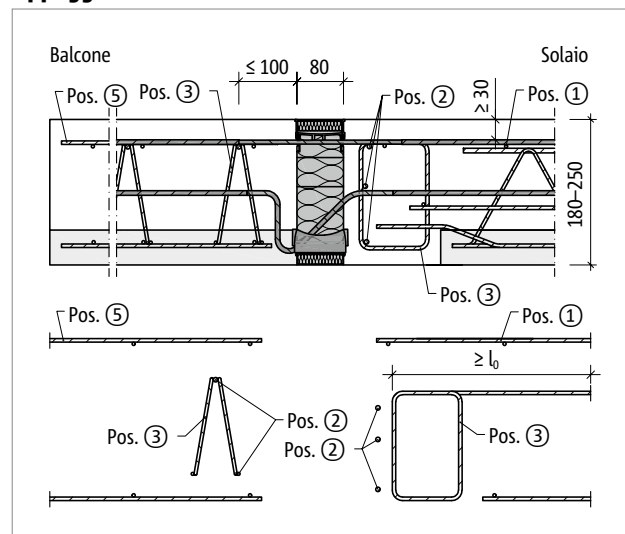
Schöck Isokorb® T tipo K-F: armatura in opera con spessore soletta del balcone $h = 180-250$ mm (Pos.2: $5\phi 8$); variante con traliccio di supporto
